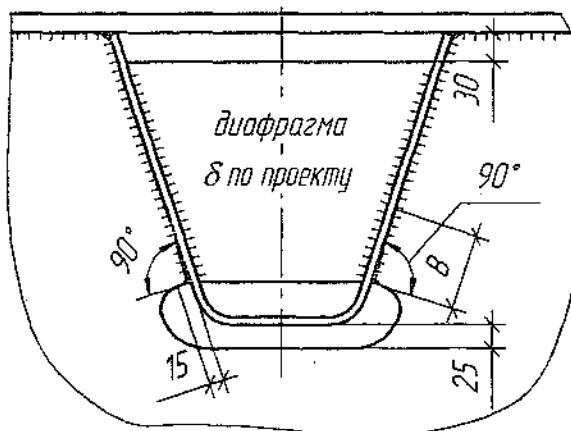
Пересечение трапециевидного продольного ребра со стенкой поперечной балки
